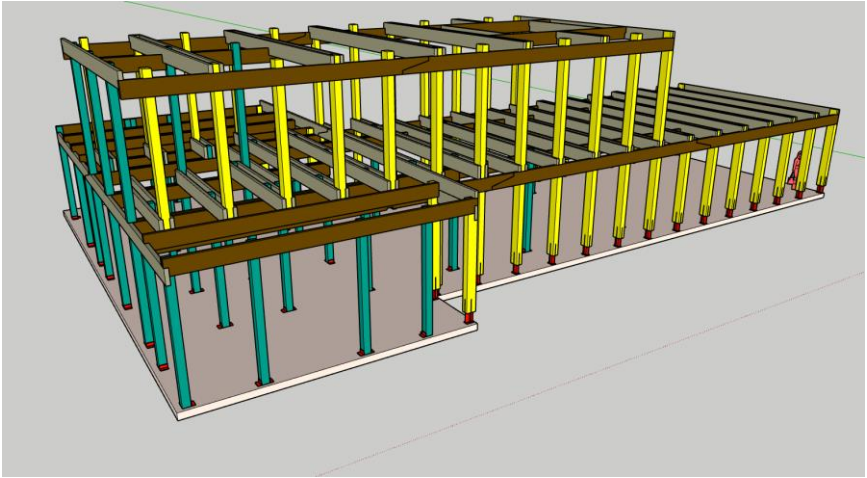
Последовательность монтажа – укладка балок покрытия и перекрытия
